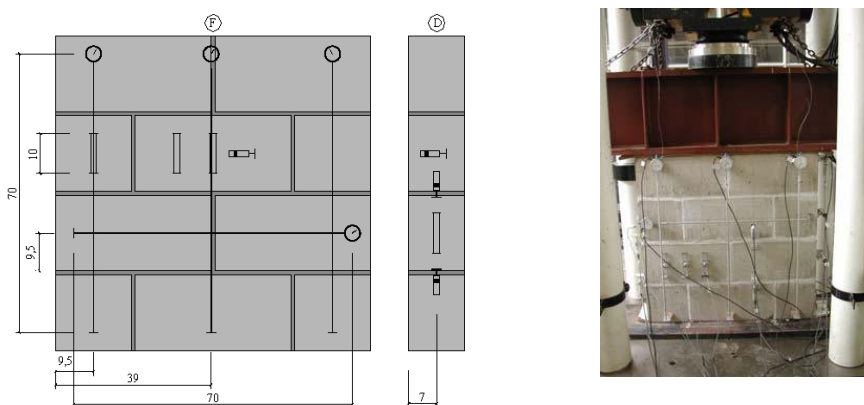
Esquema da instrumentação e ensaio da miniparede. Barbosa (2008)
